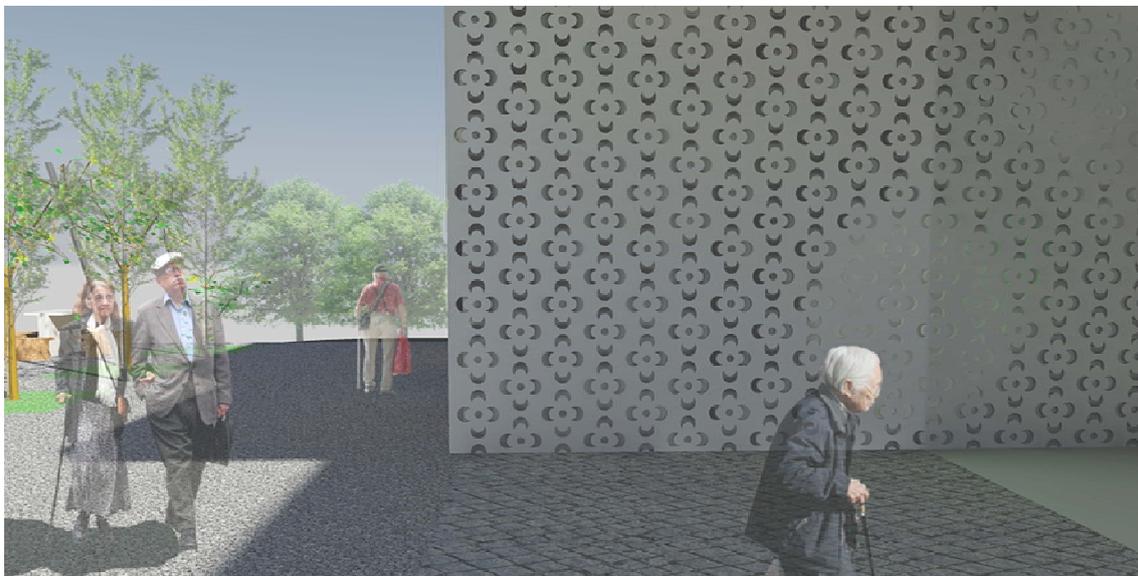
Zona da entrada. Pormenor do padrão da fachada falsa.
